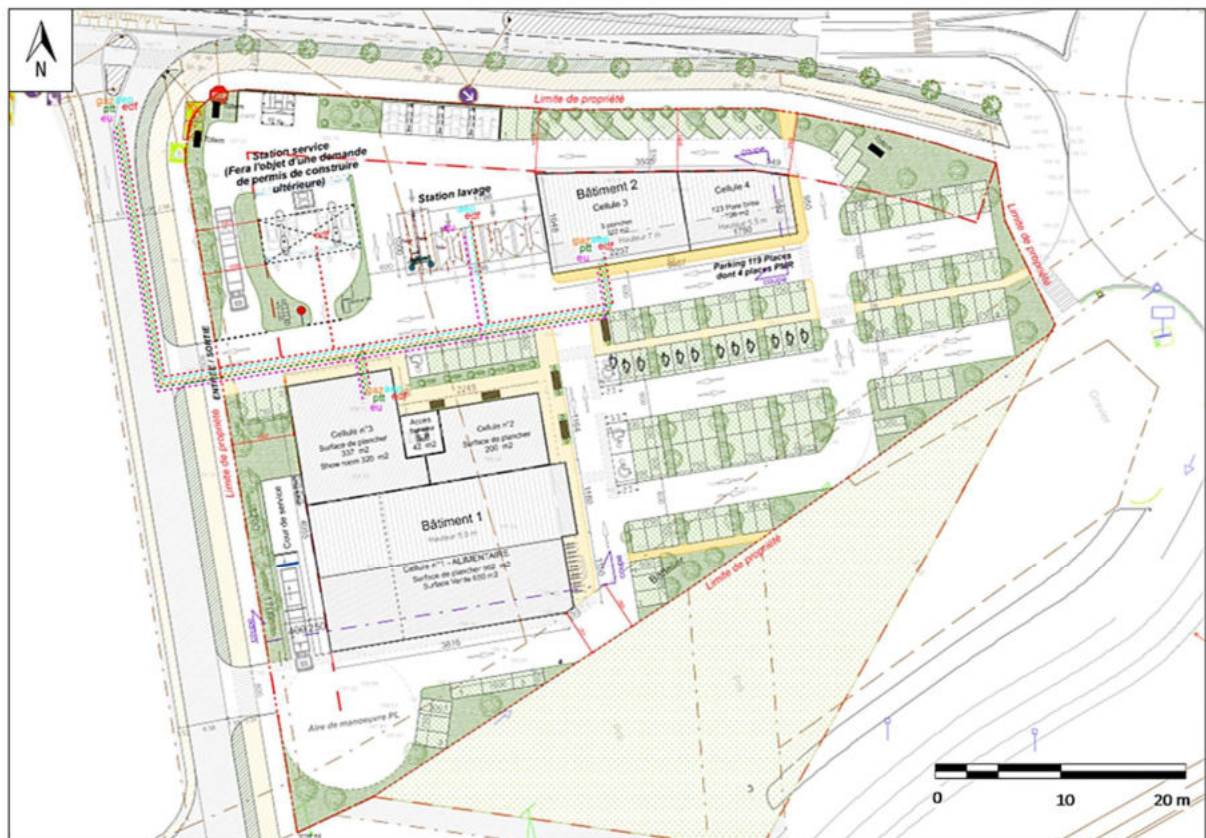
Plan masse du projet (source : SAS SEMAYORK & ARCHITECTE DESA)
